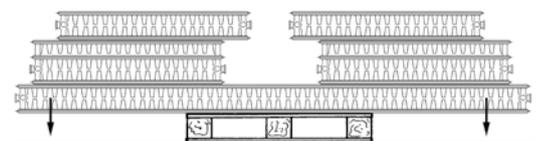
Falsche Lagerung führt zu Beschädigungen
